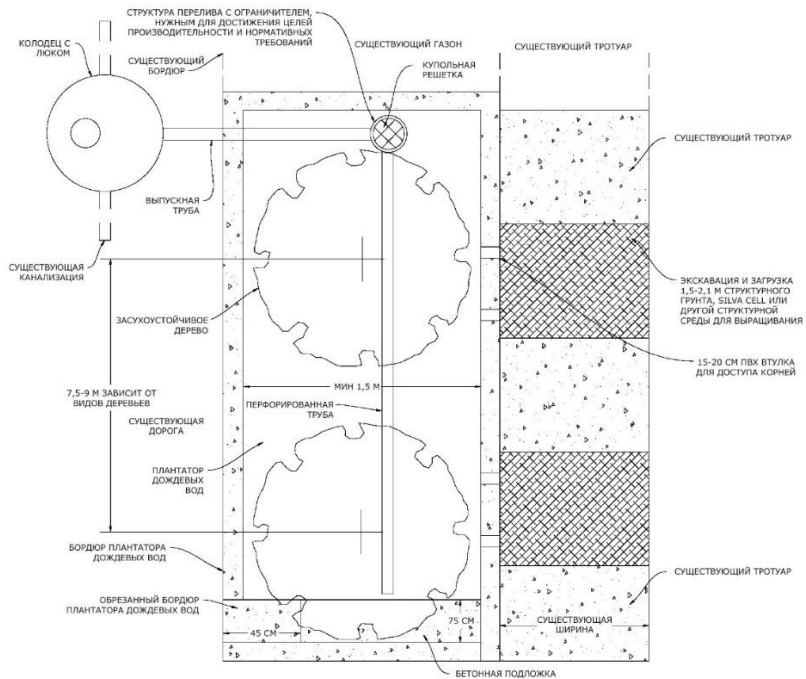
Типовой профиль плантатора с посадкой дерева (вид сверху)
